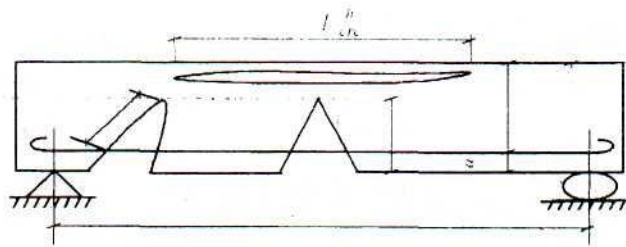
Модель разрушения железобетонного элемента на предельной стадии деформирования
